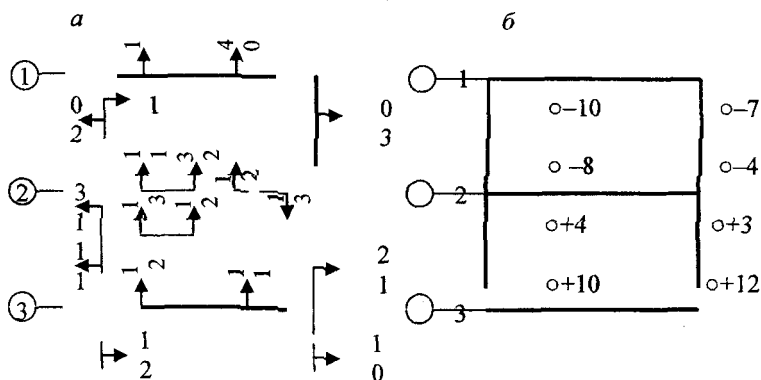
Исполнительная схема планово-высотного положения конструкций цокольного этажа: а – направление и величина смещения панели от проектного положения (над чертой – верх панели, под чертой – низ); б – точки нивелирования перекрытия над подвалом и их отклонения (в миллиметрах)
